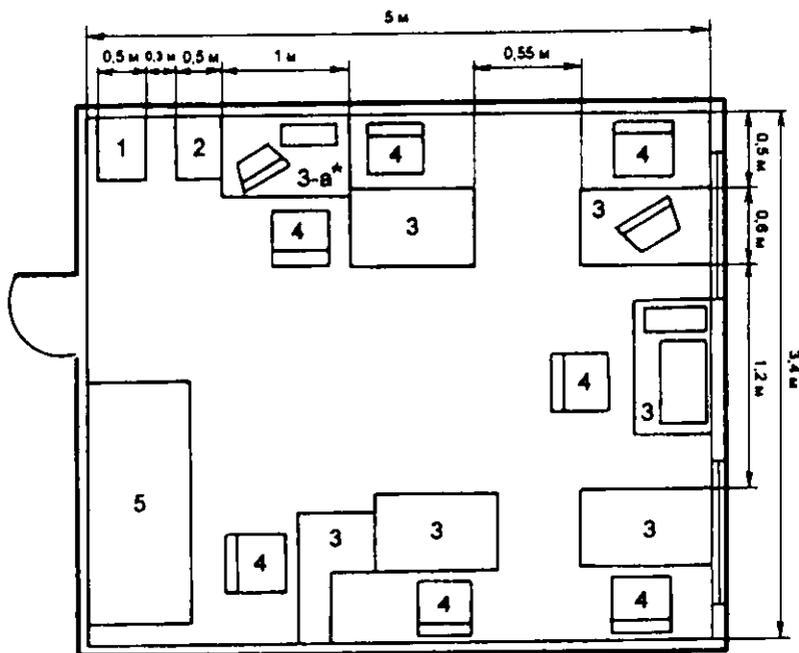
Схема размещения рабочих мест в помещении: 1 – холодильник; 2 – тумбочка для бумаг; 3 – стол (3а – мое рабочее место); 4 – стул; 5 – шкаф для одежды и бумаг
